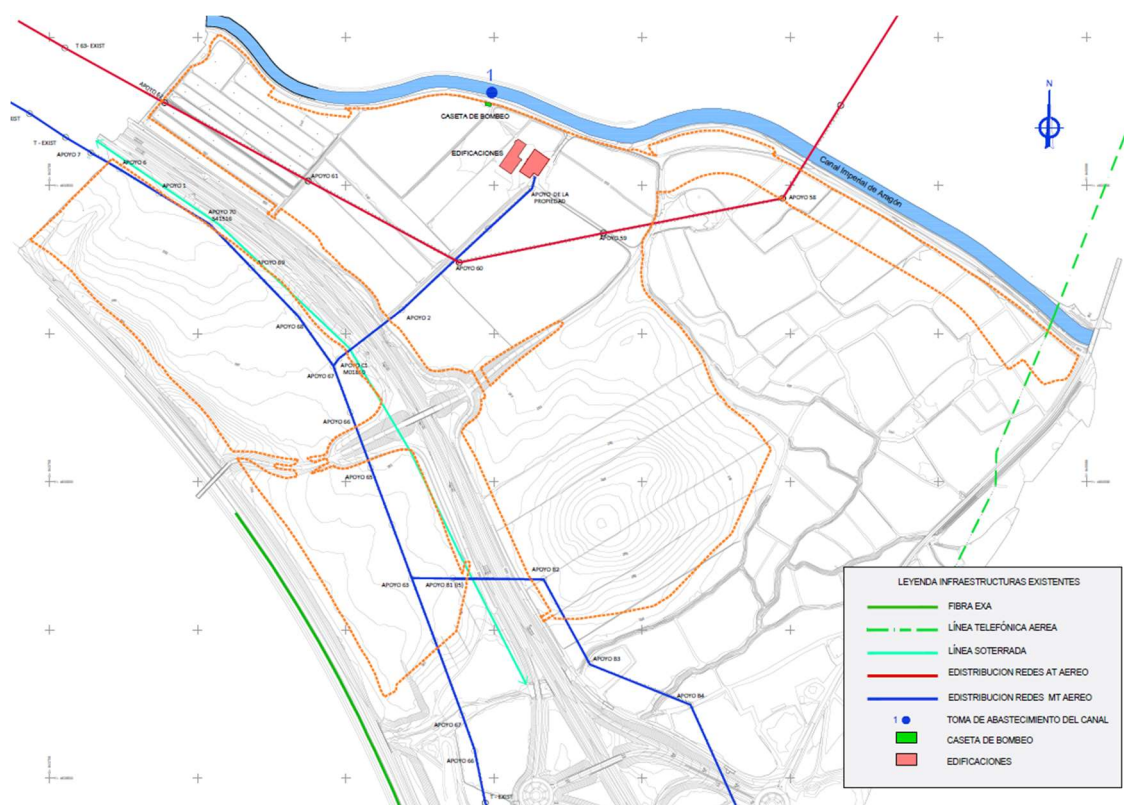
Plano 3.3 del Proyecto de Urbanización Privada Exterior "Infraestructuras existentes"
